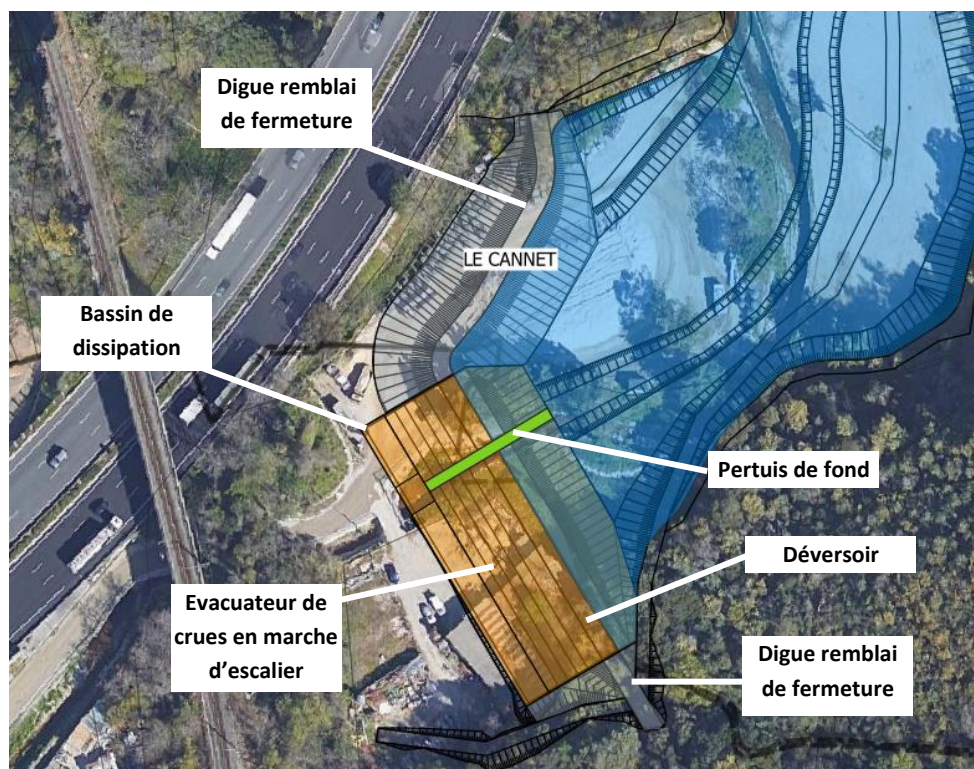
Détail de l'aménagement hydraulique de Carimaï – lignes de structures issues du plan AVP (Fond de plan Google Satellite 2023)
